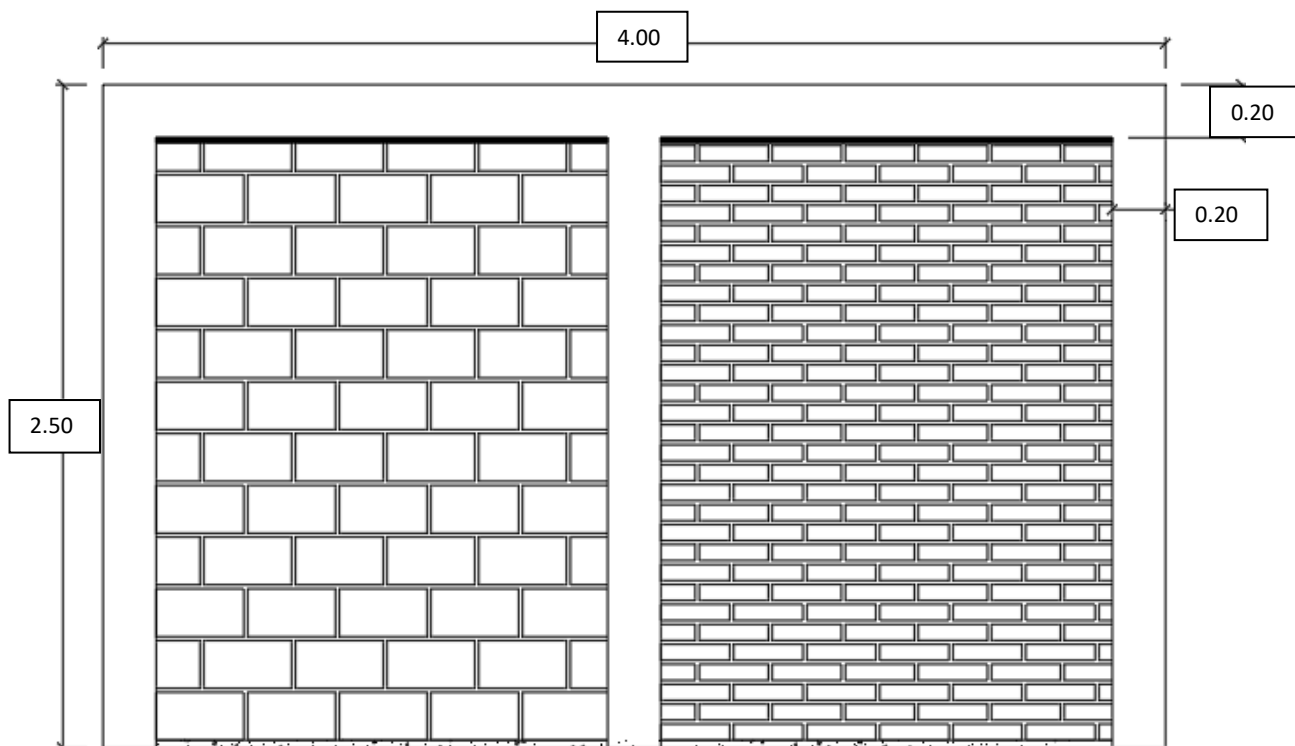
vista del muro Tipo E, doble y de construcción húmeda.
